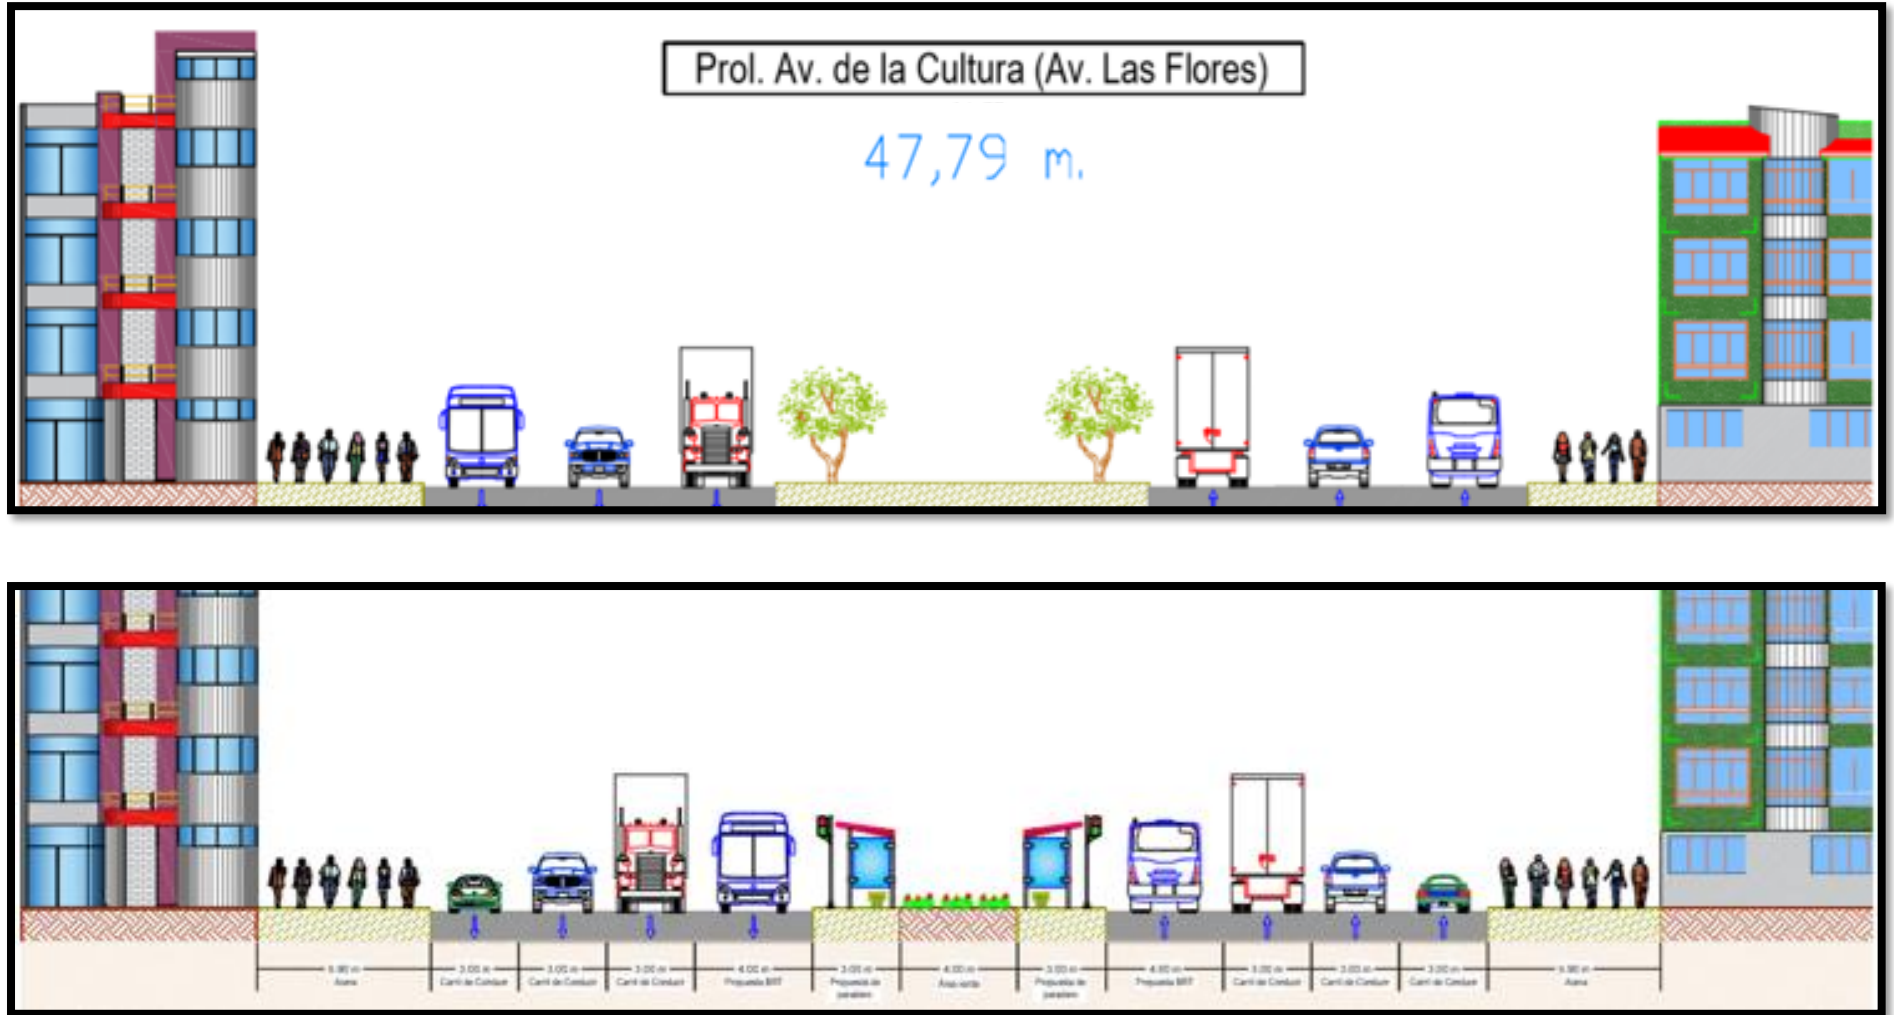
Comparación de las secciones transversales en (Av. Las Flores)
